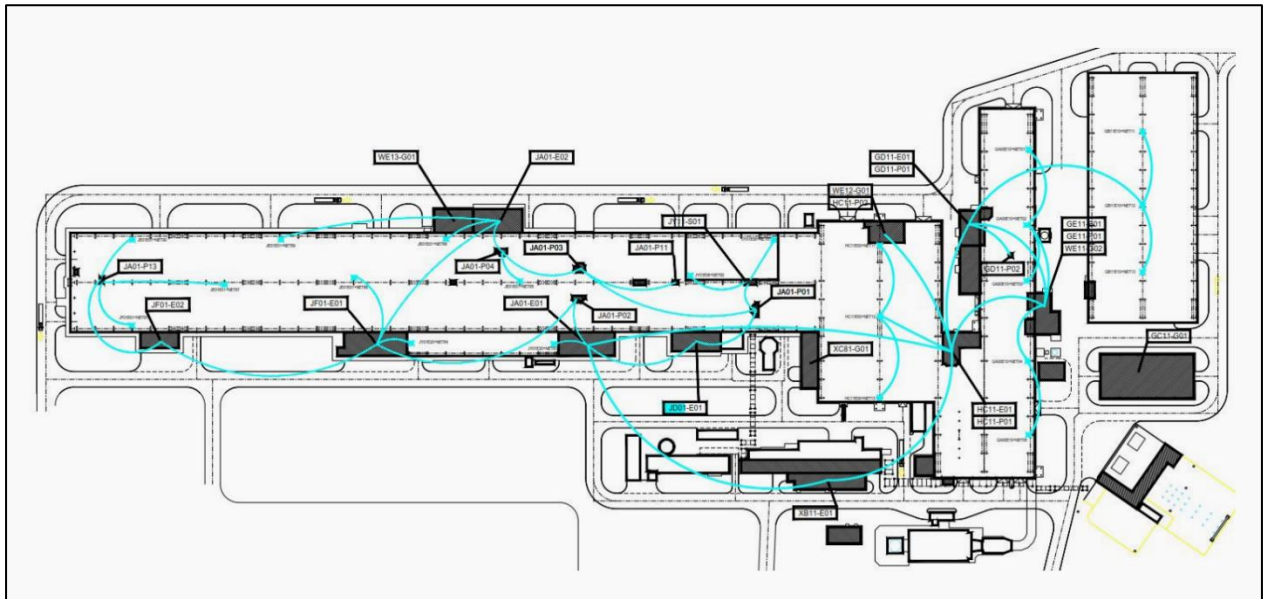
Layout de redes industriales del área laminador. Fuente: LAYOUT Laminador Planta 2
